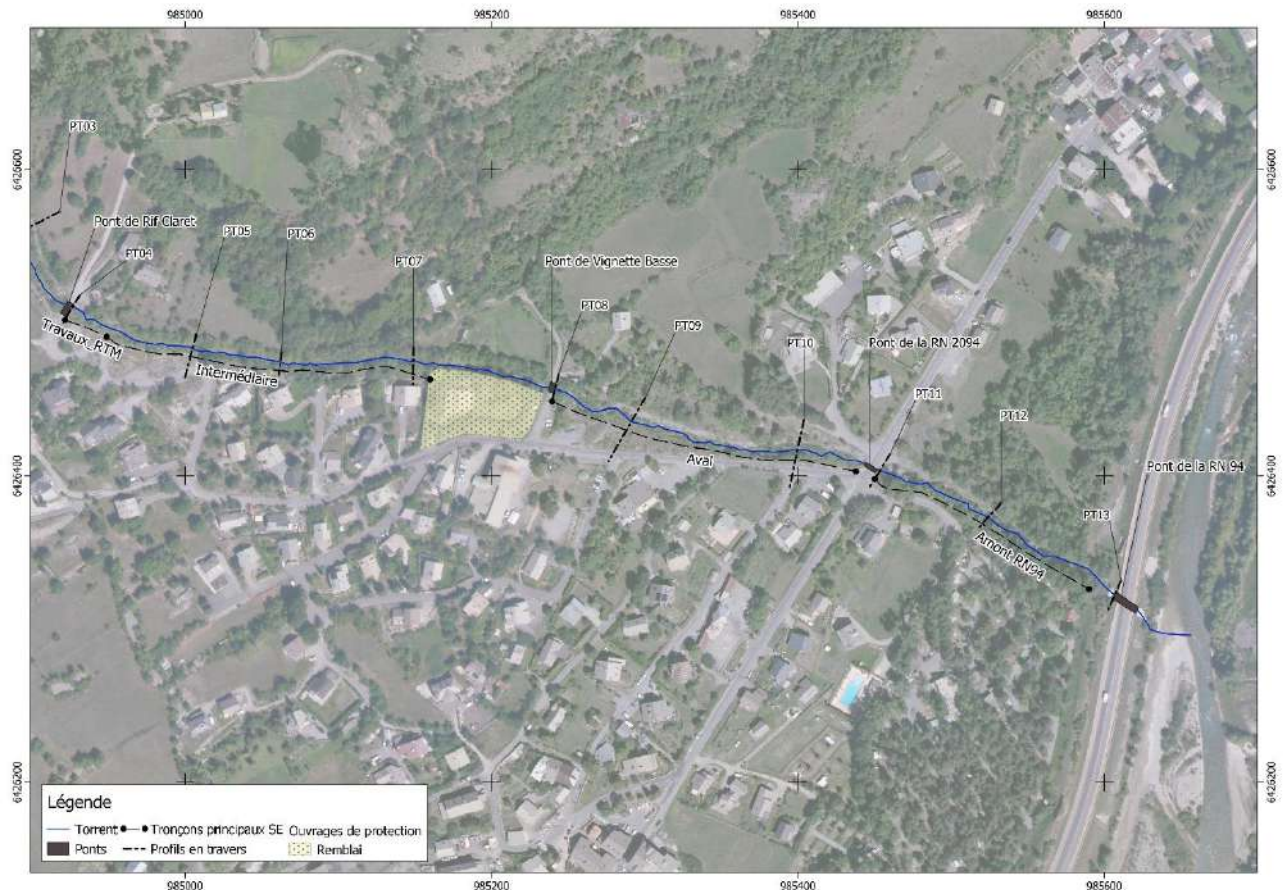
Plan d'ensemble constituant le système d'endiguement
